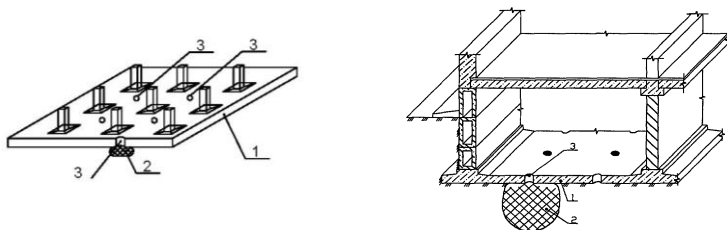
Размещение технологических каналов на примере плитного фундамента:
